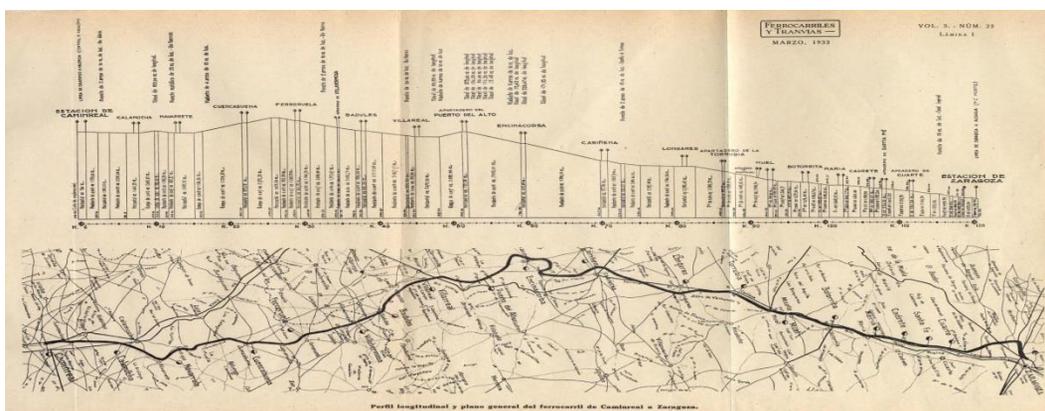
Perfil longitudinal y plano general del ferrocarril de Caminreal a Zaragoza. Fuente: Archivo AHF, 1933)
